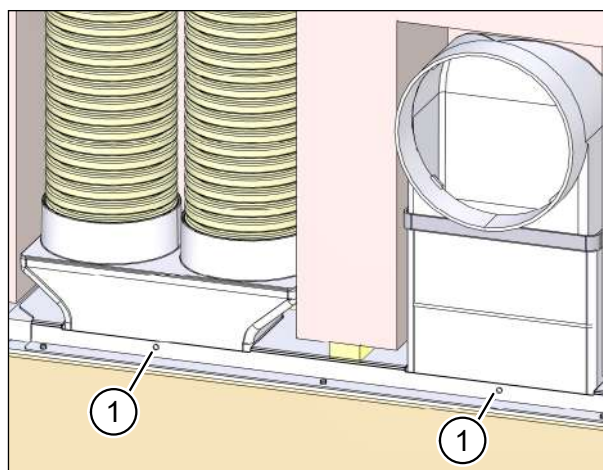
Fissaggio degli allacciamenti per canale piatto / tubo flessibile nella cassetta a muro
